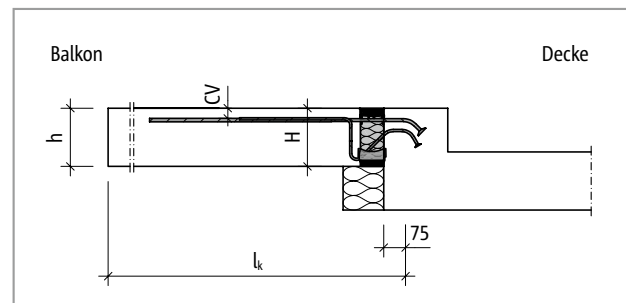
Schöck Isokorb® T Typ K-O: Statisches System
